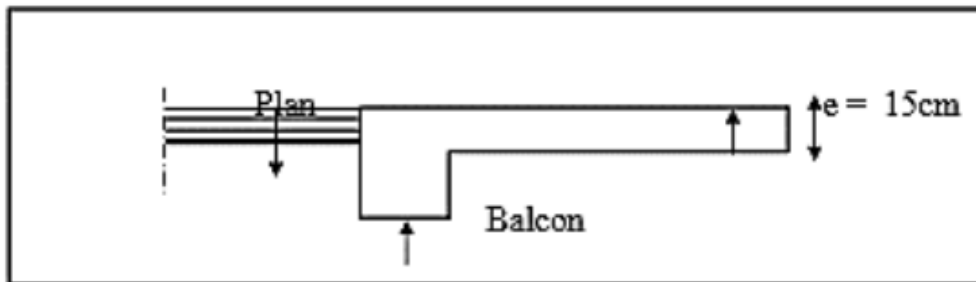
coupe verticale détaillant la liaison balcon- poutre de rive.
